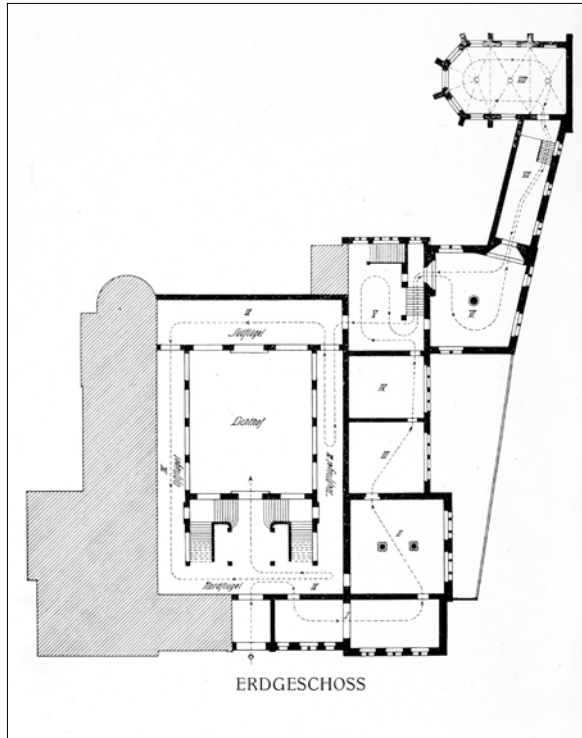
Altbau des Landesmuseums, Grundriss nach Hermann Schaedtler, Erdgeschoss, 1913.
